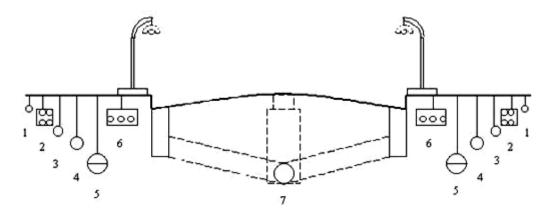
Размещение подземных сетей в профиле улицы 1 — электрокабель; 2 — телефонный кабель; 3 — газопровод; 4 — водопровод; 5 — бытовая водоотводящая сеть; 6 — тепловая сеть; 7 — дождевая водоотводящая сеть
